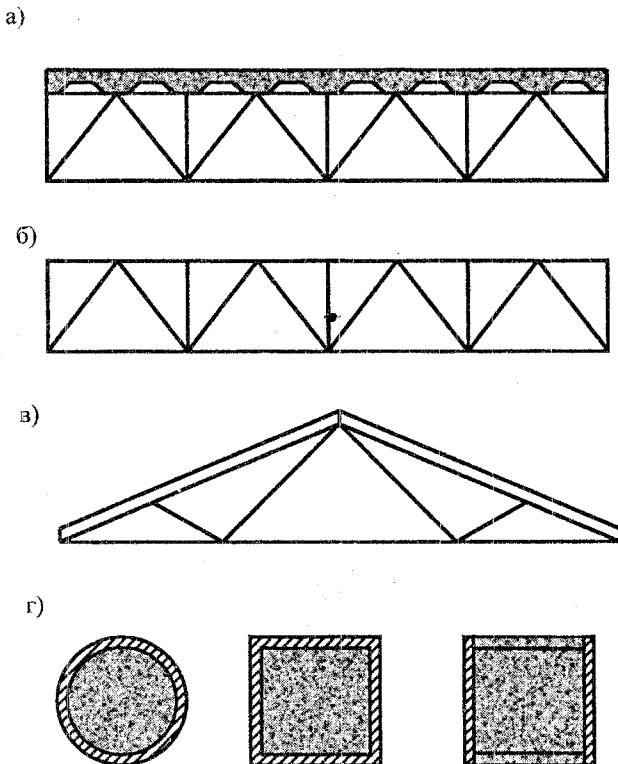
Схеми сталезалізобетонних ферм:
